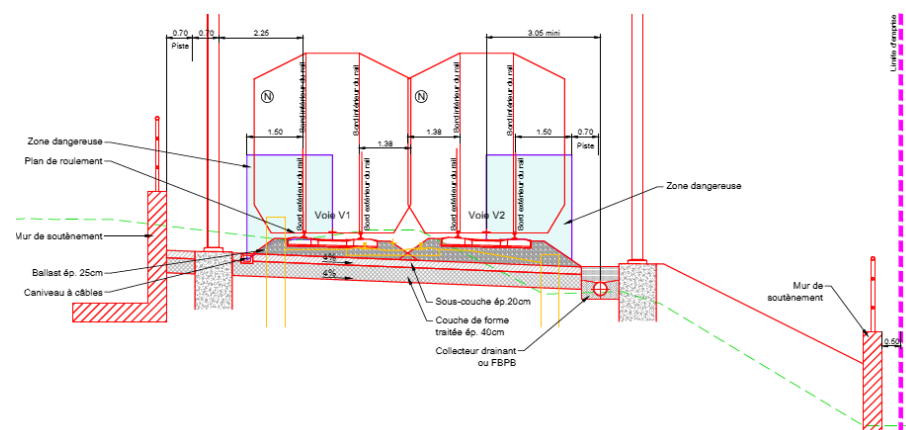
coupe type en zone de remblai avec mur de soutènement en pied de remblai
